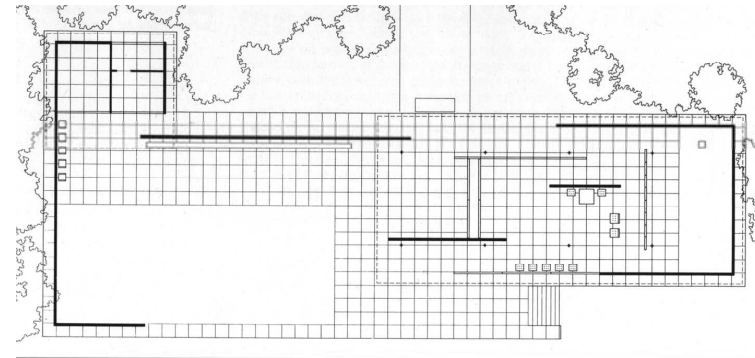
Mies (planta do Pavilhão de Barcelona), 1929
